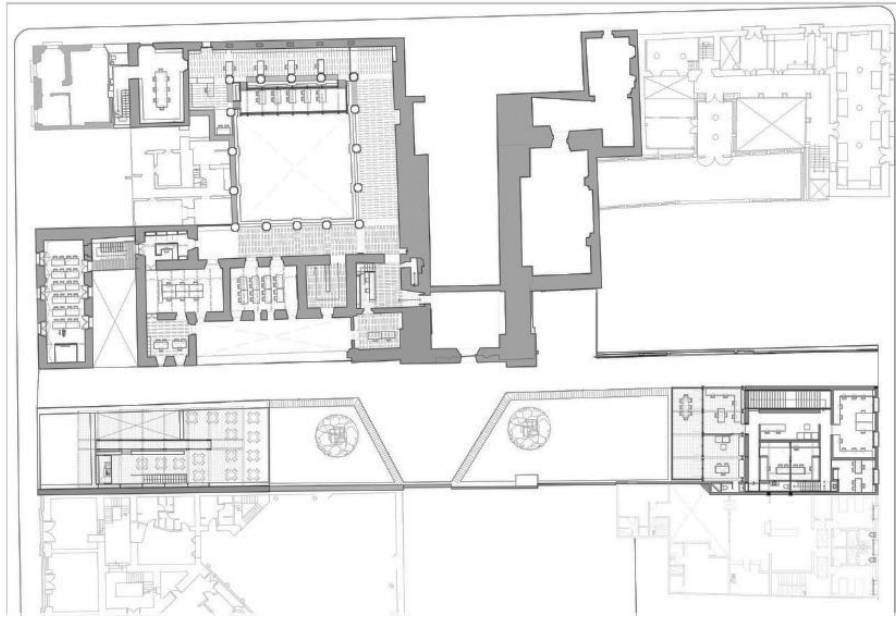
Planta Primer Nivel (Centro Académico y Cultural San Pablo) | Fuente: Archdaily
